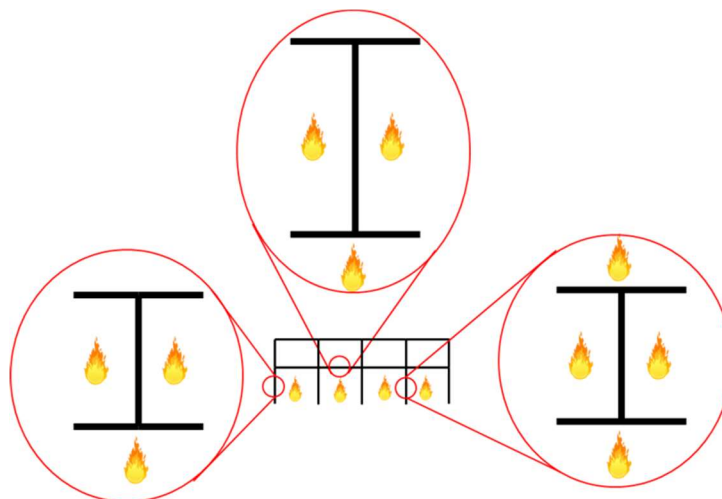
Exposition au feu des poteaux et poutres de la structure
